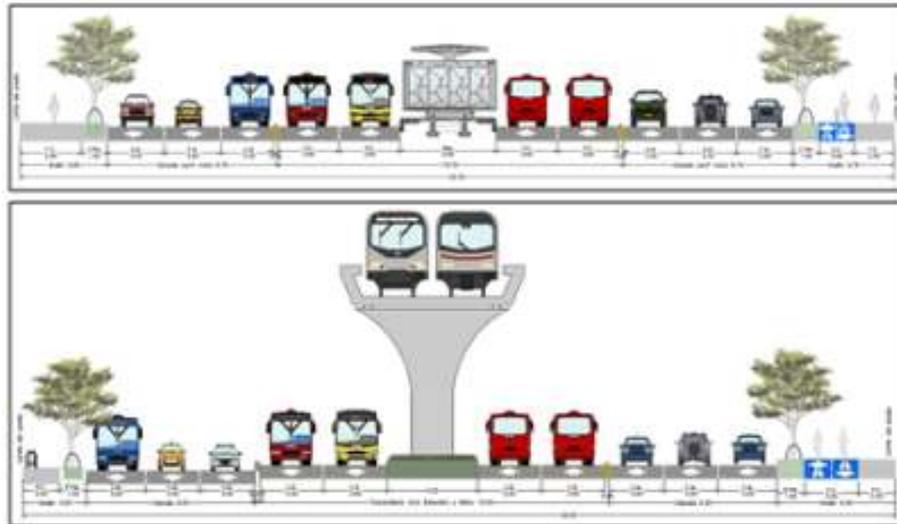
Sección transversal a nivel entre estaciones en la Avenida Norte Quito Sur (NQS) entre la Avenida 1ra de Mayo y la Avenida Octava Sur. Fuente: Elaboración Propia 2017.
